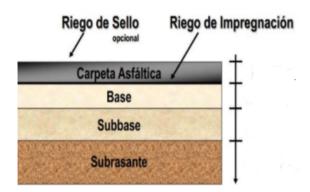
Estructura de un pavimento Flexible. Recuperado de: Proceso constructivo del Pavimento flexible. Civilneting (2019)
